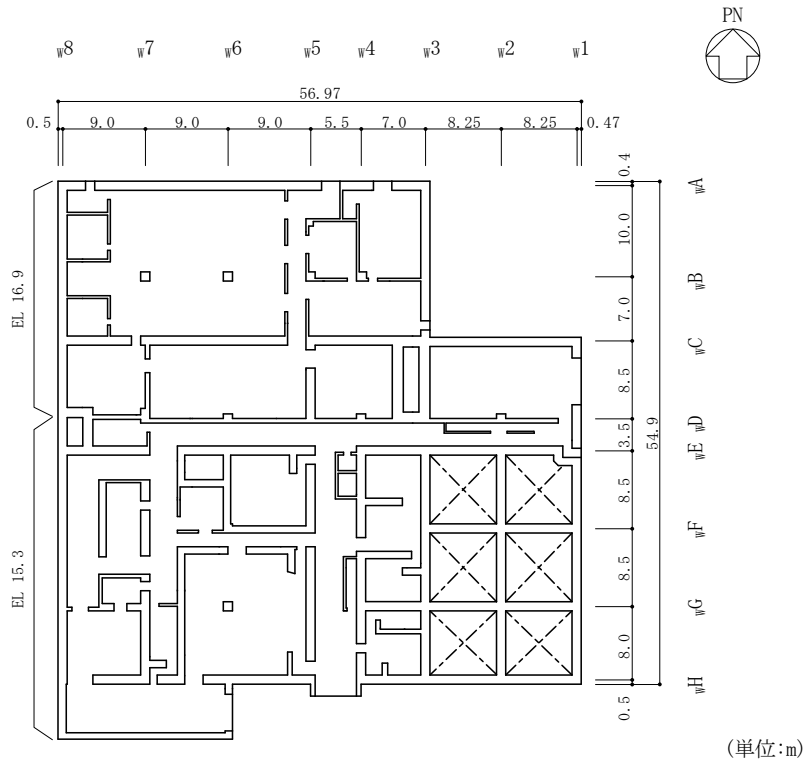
(4) 廃棄物処理建物の概略平面図 (EL 15.3m, EL 16.9m)
